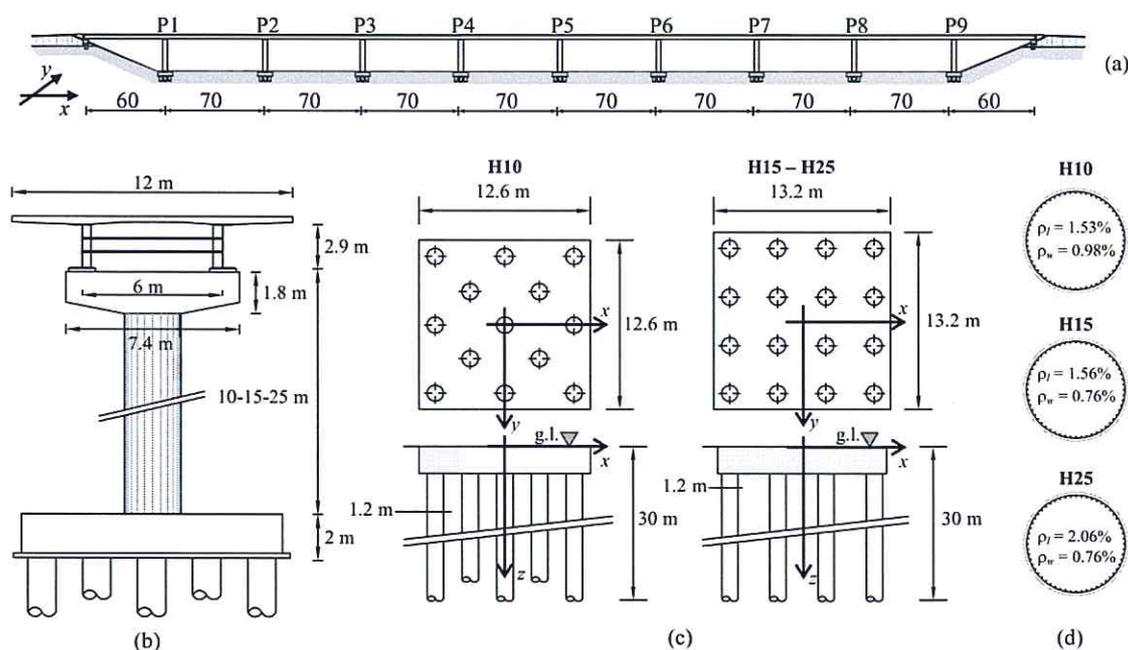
(a) Vista laterale del viadotto; (b) Pila in elevazione; (c) fondazione (d) armature longitudinale e trasversale della pila
